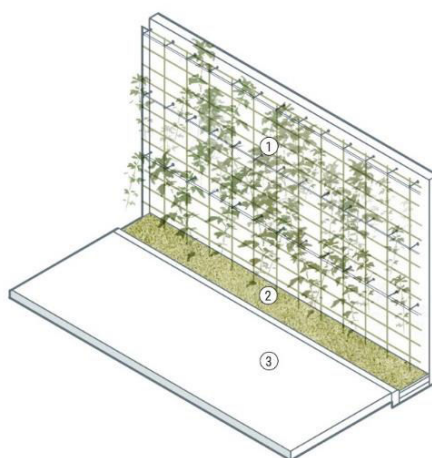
Exemplificare de fațade verzi bazate pe sol. 1 - sistem de susținere a plantelor la nivelul fațadei; 2 - jardiniere sau spații verzi amenajate perimetral clădirilor; 3 - zonă pietonală sau rutieră.
